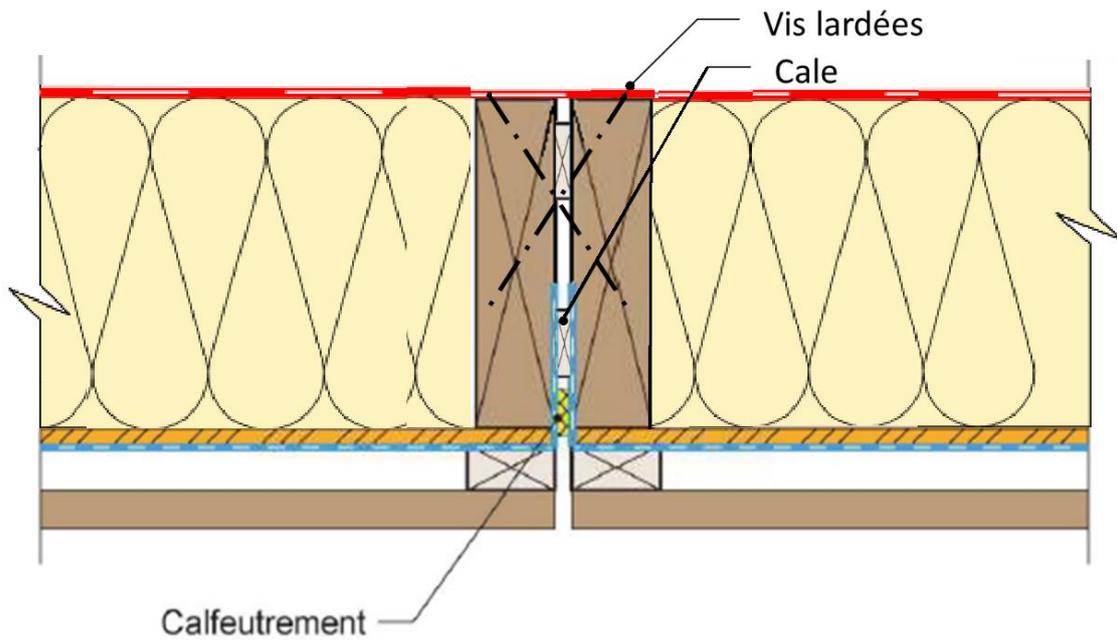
Exemple de positionnement du calfeutrement dans le plan du pare-pluie et assemblage par vis lardées de deux parois dans le même plan (coupe horizontale)
